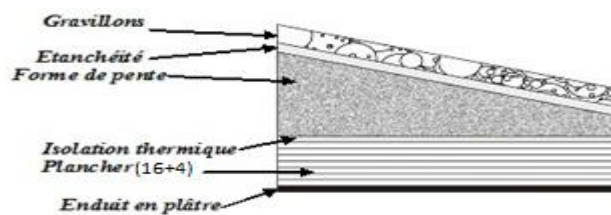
Coupe transversale du plancher de la terrasse inaccessible.
